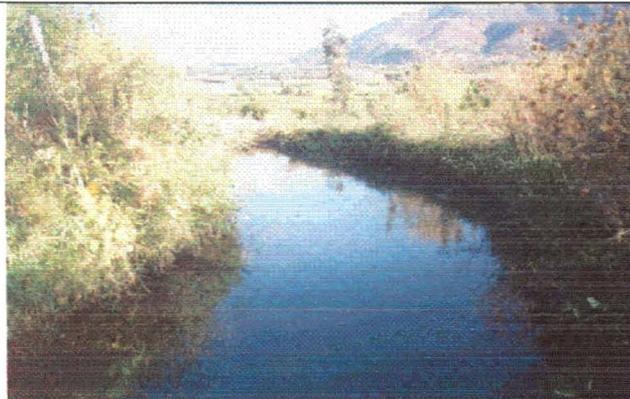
Sección. Tramo de sección irregular donde se observan filtraciones y problemas de desbordes.
